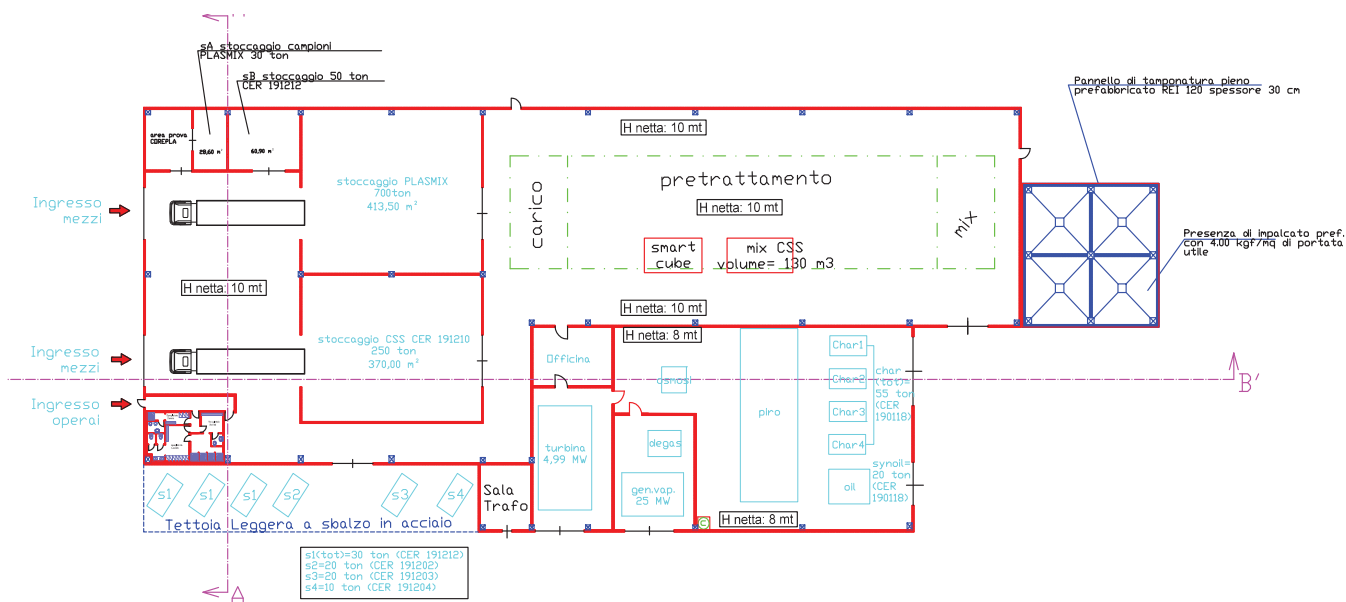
Layout impianto. si distinguono, la zona di conferimento e scarico camion, la zona di pretrattamento rifiuto e la zona di pirolisi e generazione.
